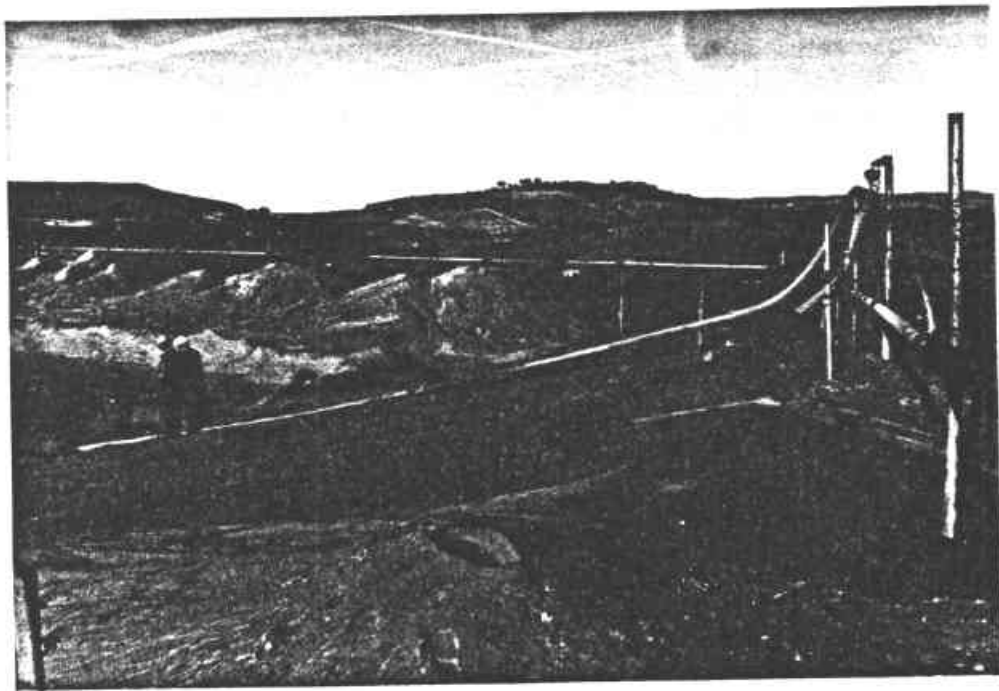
Construction de la digue du bassin n° 5. Cyclonage des
